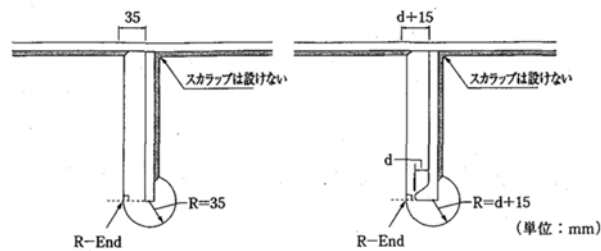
平板リブ又はバルブプレートリブと中間横リブ又は横桁との交差部構造の標準
